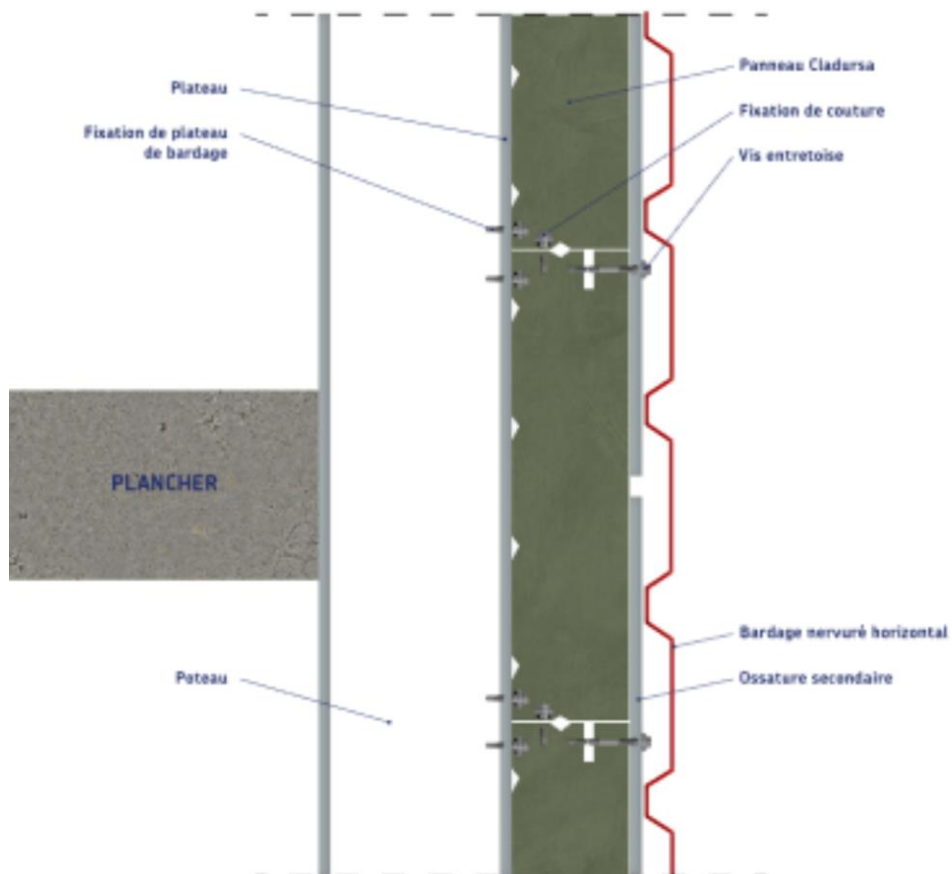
Exemple d'interruption d'ossature avec la peau extérieure continue au droit d'un plancher en zones sismiques
